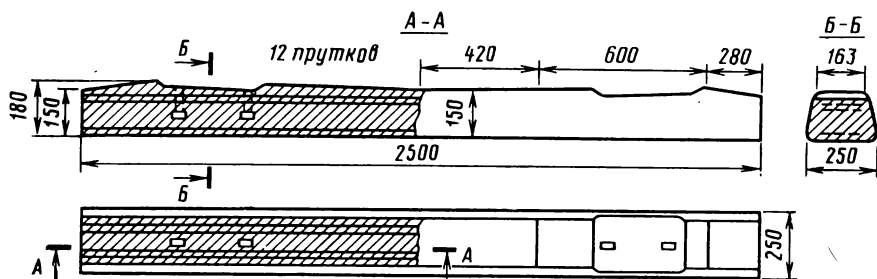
Железобетонная трамвайная шпала ЛШ-5
